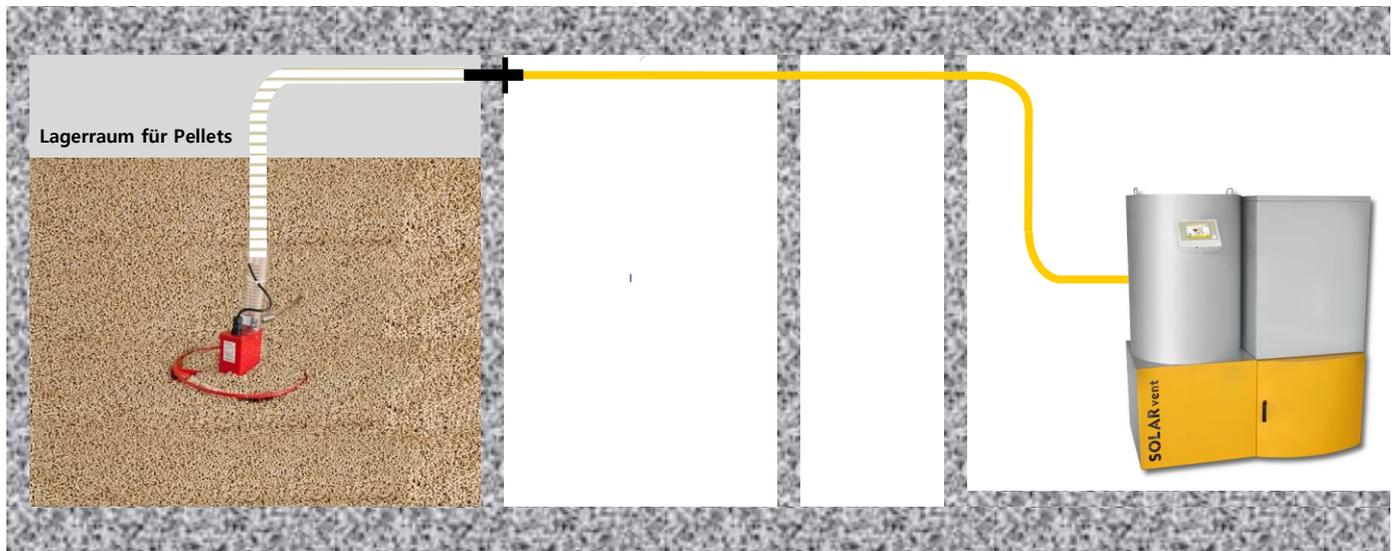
Vorschlag zur Saugschlauchverlegung von einem Pellet-Lagerraum mit Pellet-Maulwurf bzw. Pellet-Maulwurf-Tank
